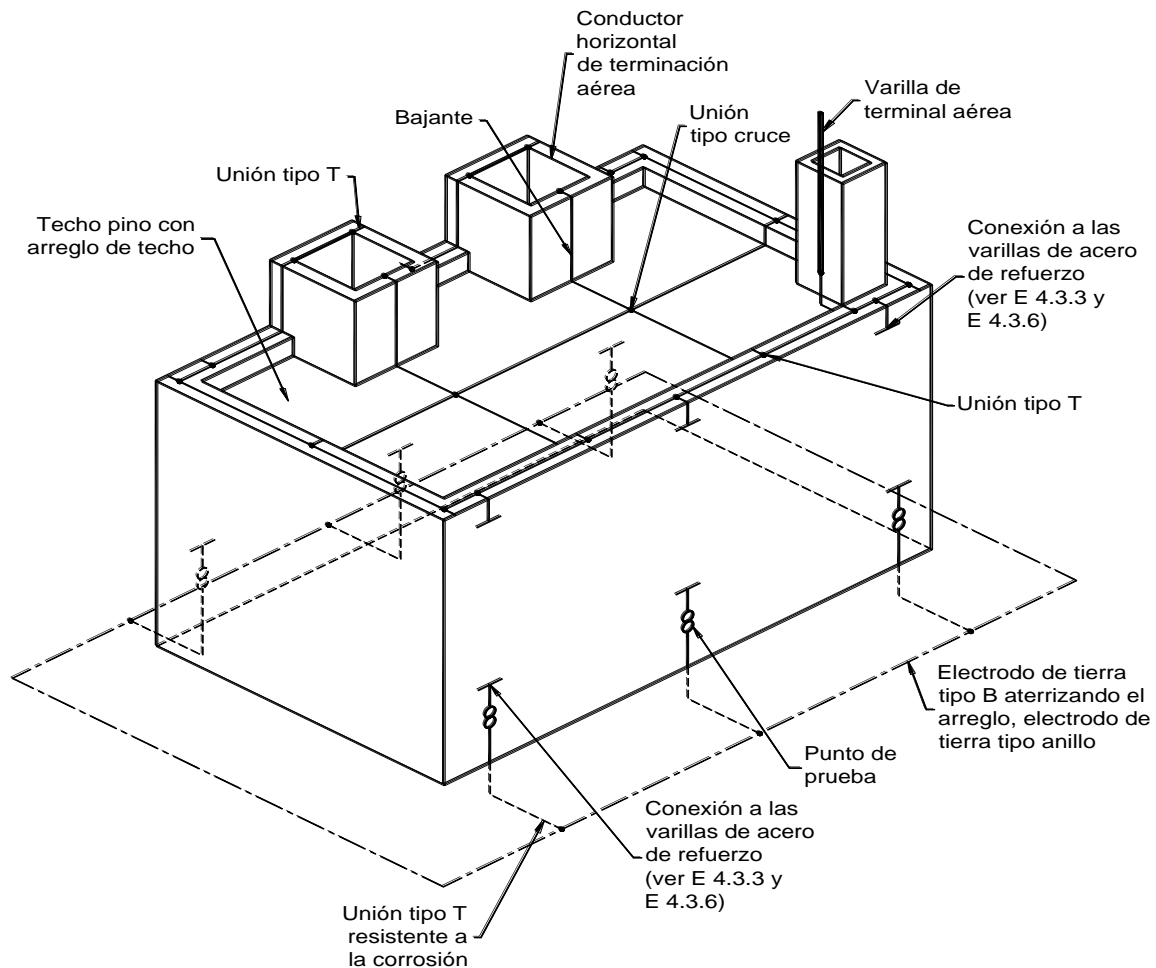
Construcción de un SIPRA externo sobre una estructura de concreto reforzado con acero usando el refuerzo de las paredes externas como componentes naturales
